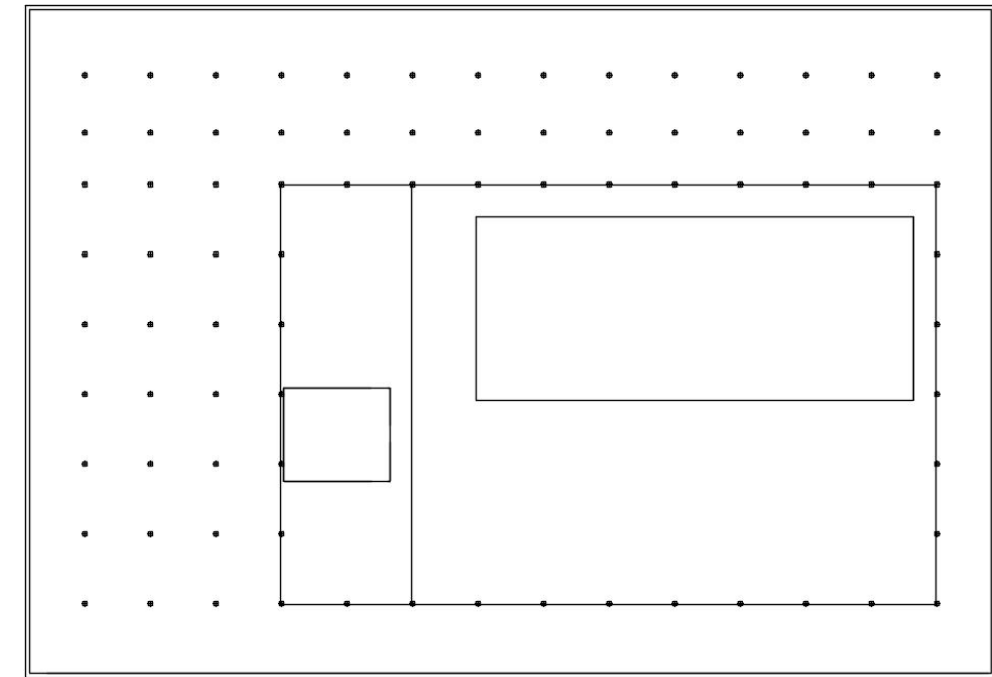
Distribución en planta con estructura piscina. Fuente: Propia
